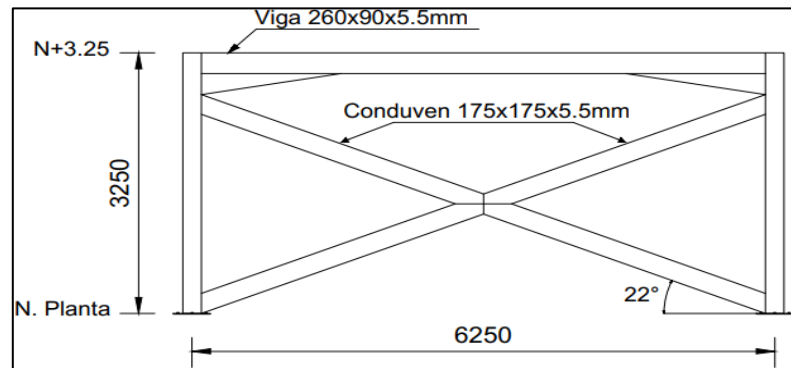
Pórtico entre N. Planta y N+3.25, con arriostamiento lateral en “X”, viga 260x90x5.5mm, y luz de 6.25m
